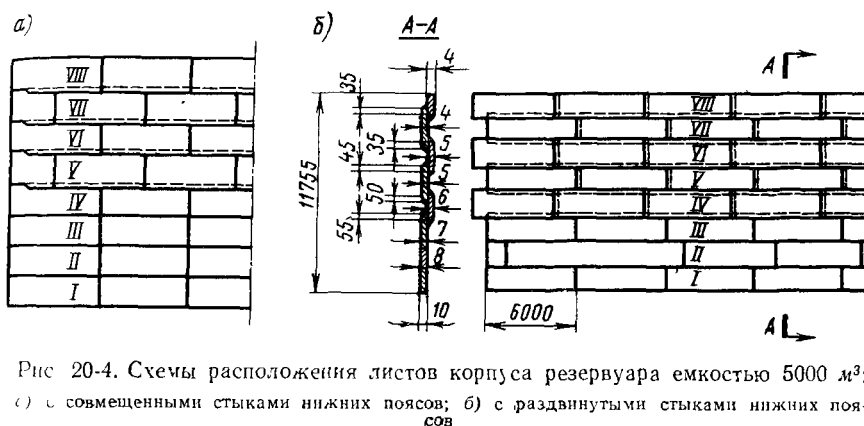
Схемы расположения листов корпуса резервуара емкостью 5000 м³: а) с совмещенными стыками нижних поясов; б) с раздвинутыми стыками нижних поясов
